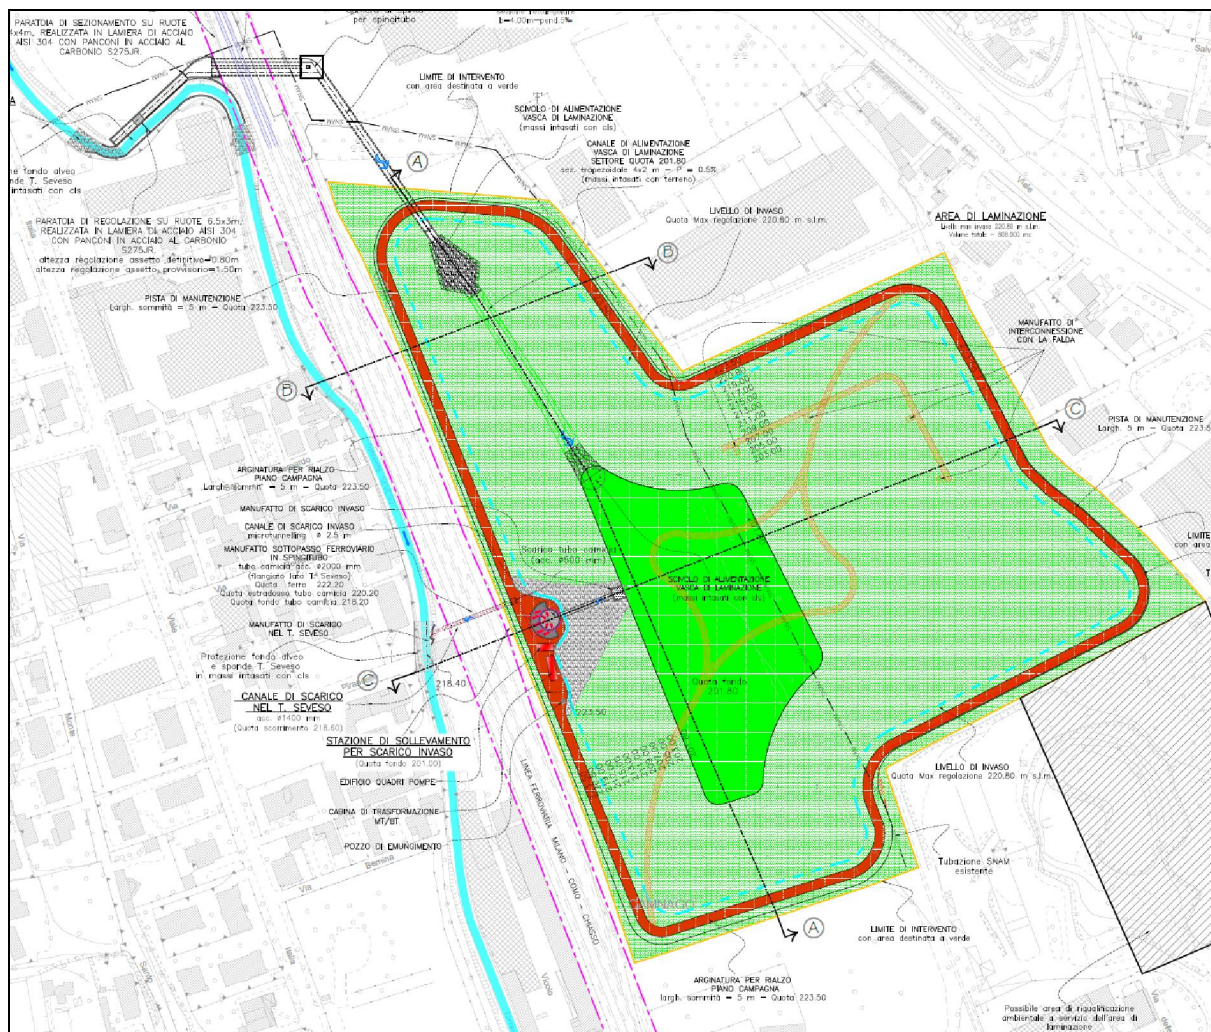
Schema planimetrico dell'area di laminazione in scavo di Lentate sul Seveso
